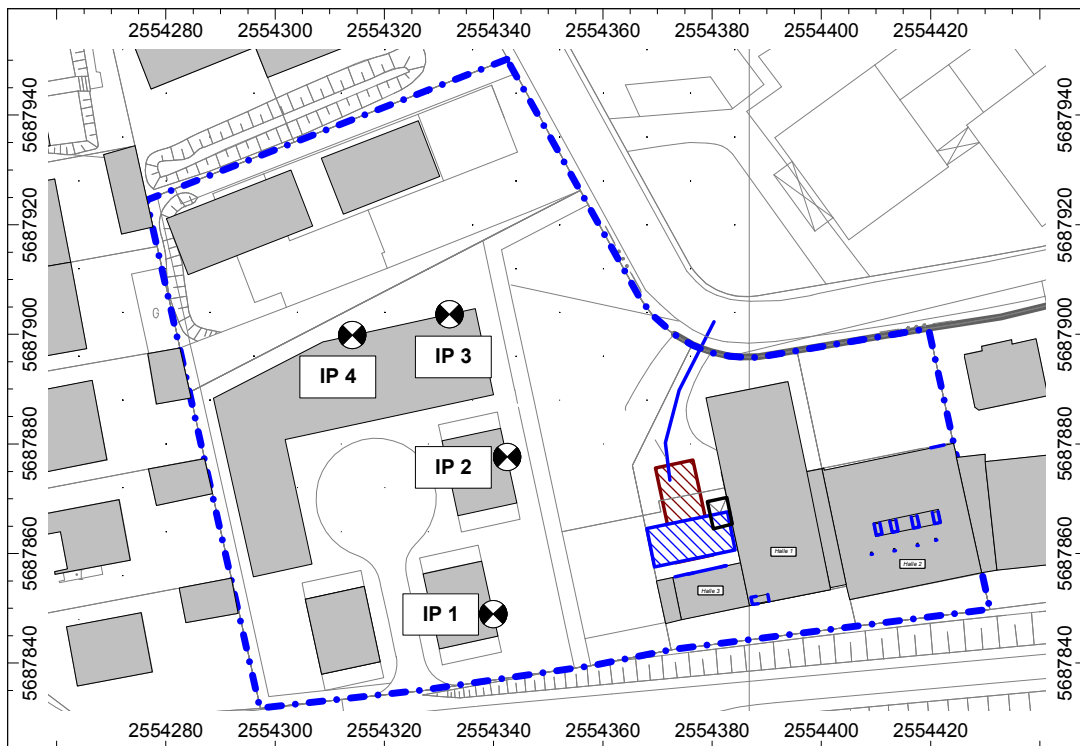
Lageplan mit den Quellen des Bestandsbetriebes des Papierveredelungsbetriebes
